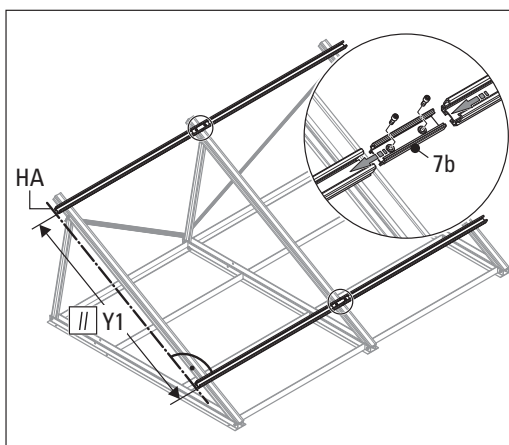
Montar las guías de perfil de montaje, 1er paso
